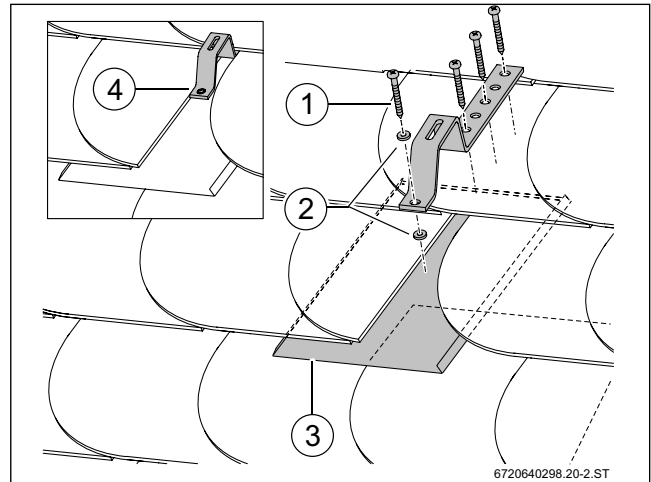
Специальный кровельный крючок с водонепроницаемой накладкой для прикрепления монтажного комплекта для гелиоколлекторов поверх шиферной или гонтовой кровли
